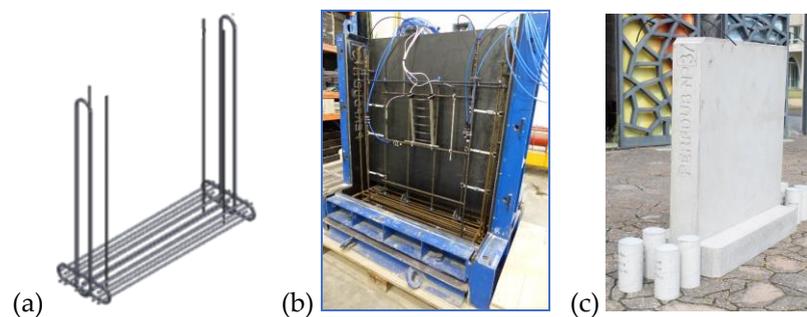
Corps d'épreuve : (a) ferrailage, (b) coffrage d'un mur instrumenté, (c) après décoffrage.
